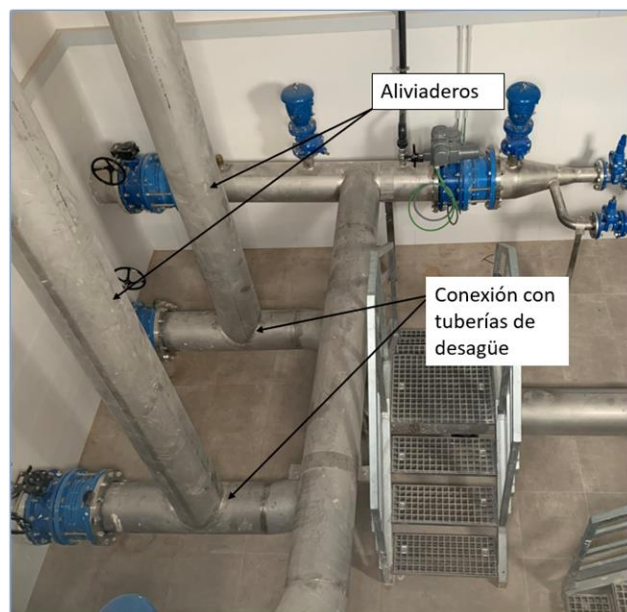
Detalle de conexión de tuberías de alivio con desagües de fondo de las cámaras
